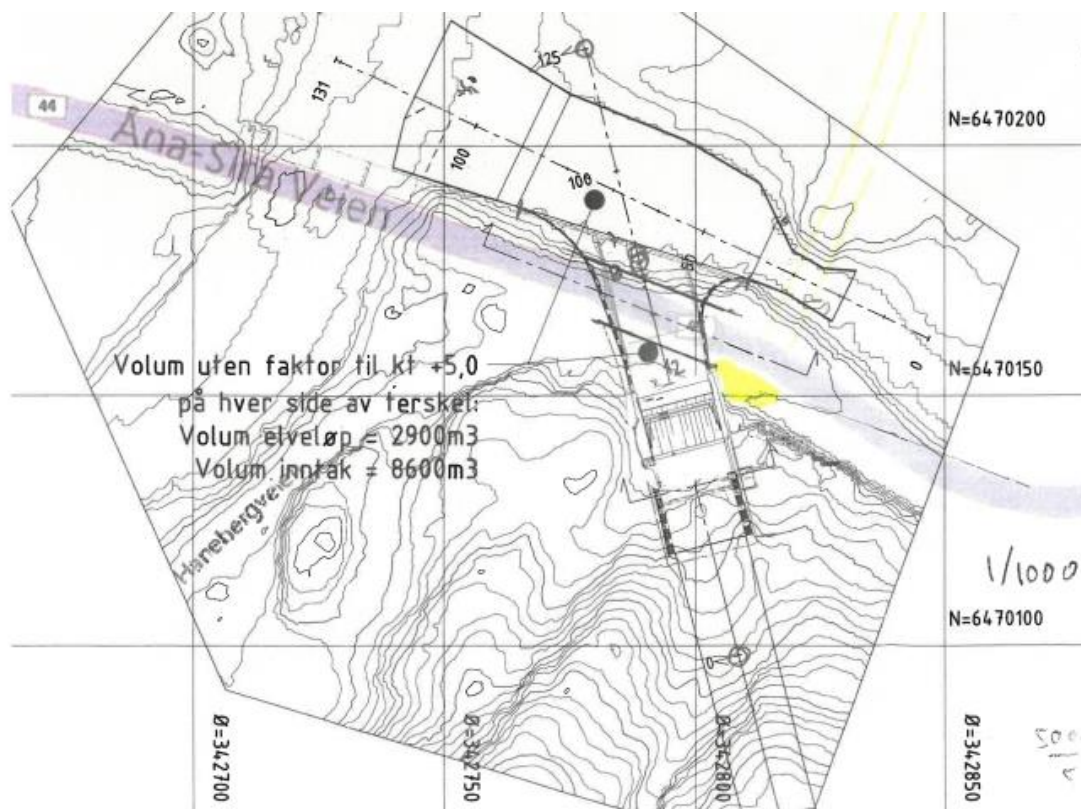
Skisser inngrep eksisterende brukonstruksjon samt plansnitt damkonstruksjon tilknyttet brukonstruksjon
